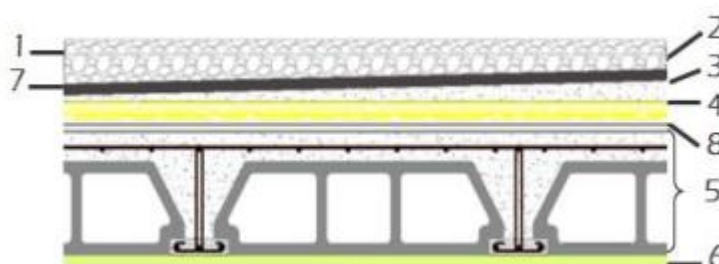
Coupe d'un plancher terrasse en corps creux (inaccessible)
